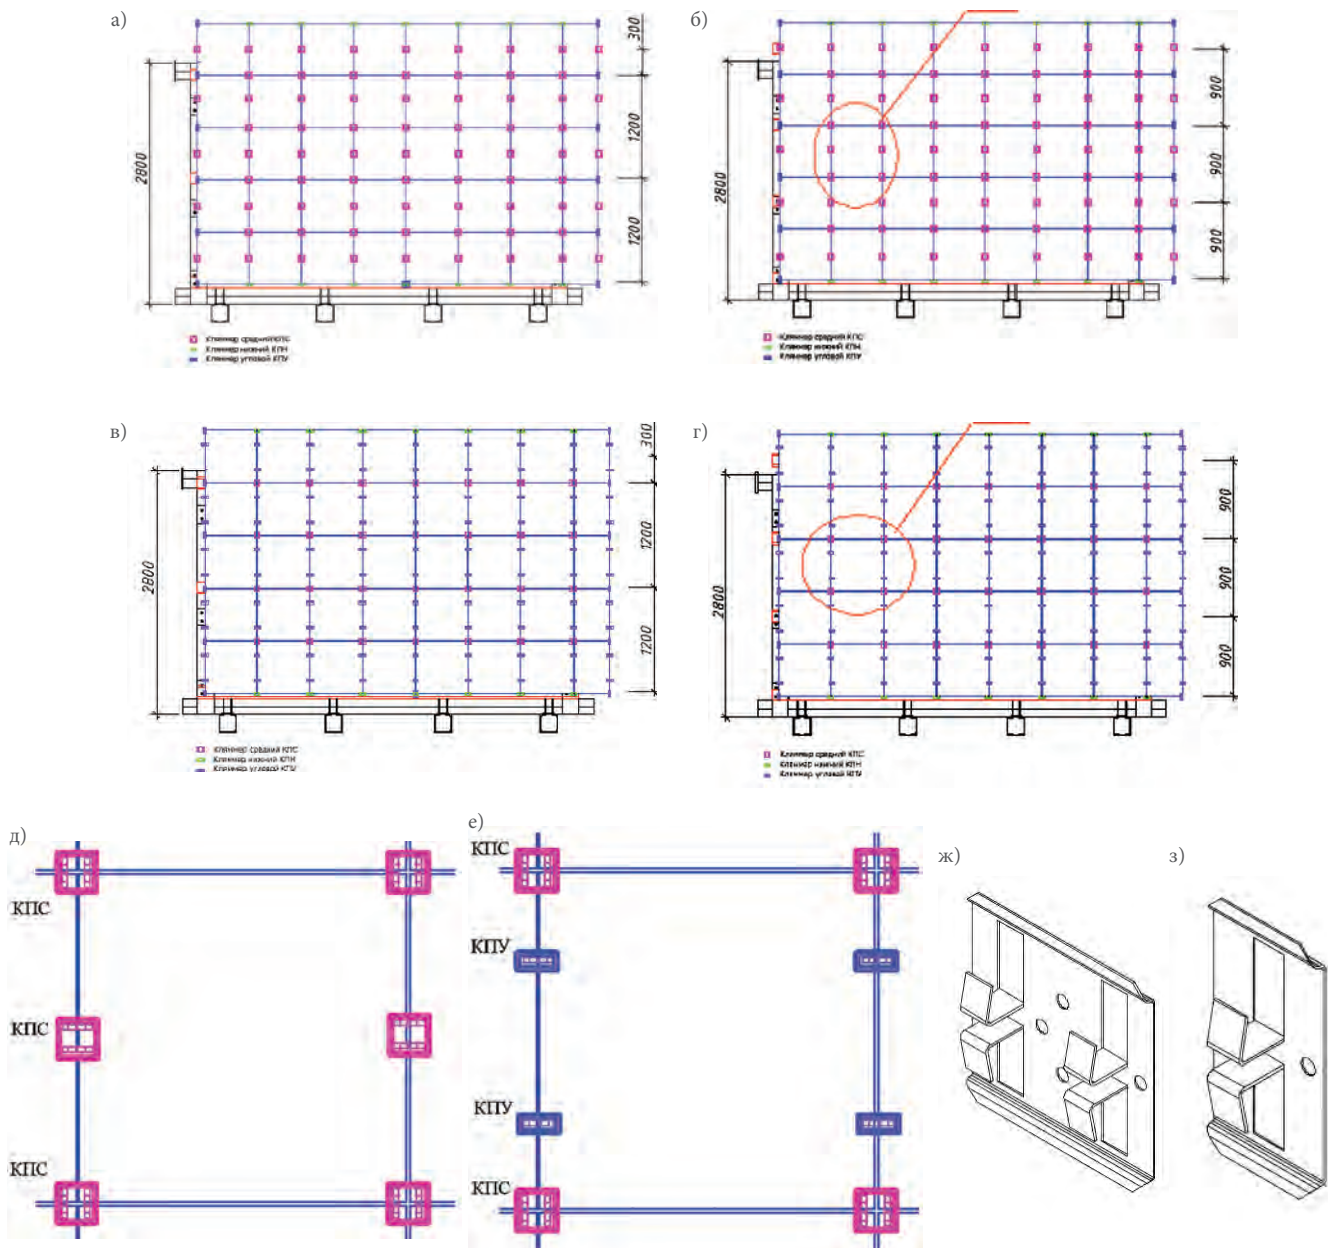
Схемы испытательных стендов с конструкциями ФС «MAVent»:
